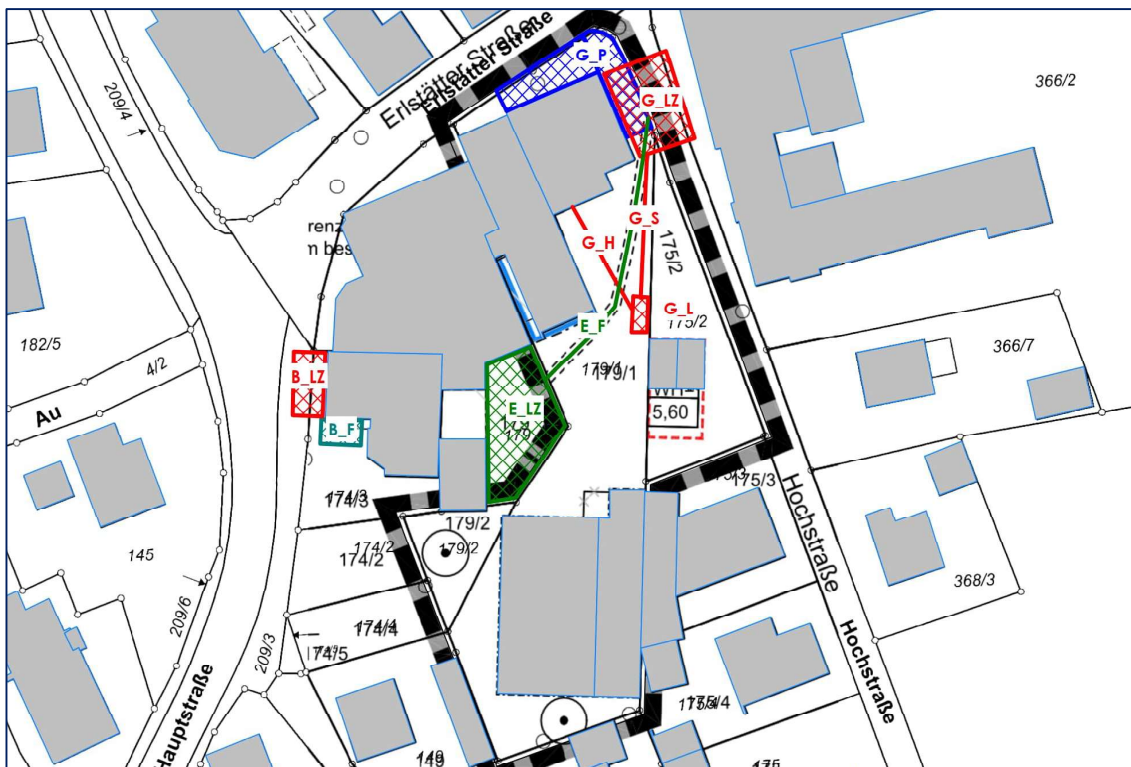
Lageplan mit Darstellung der relevanten Schallquellen
